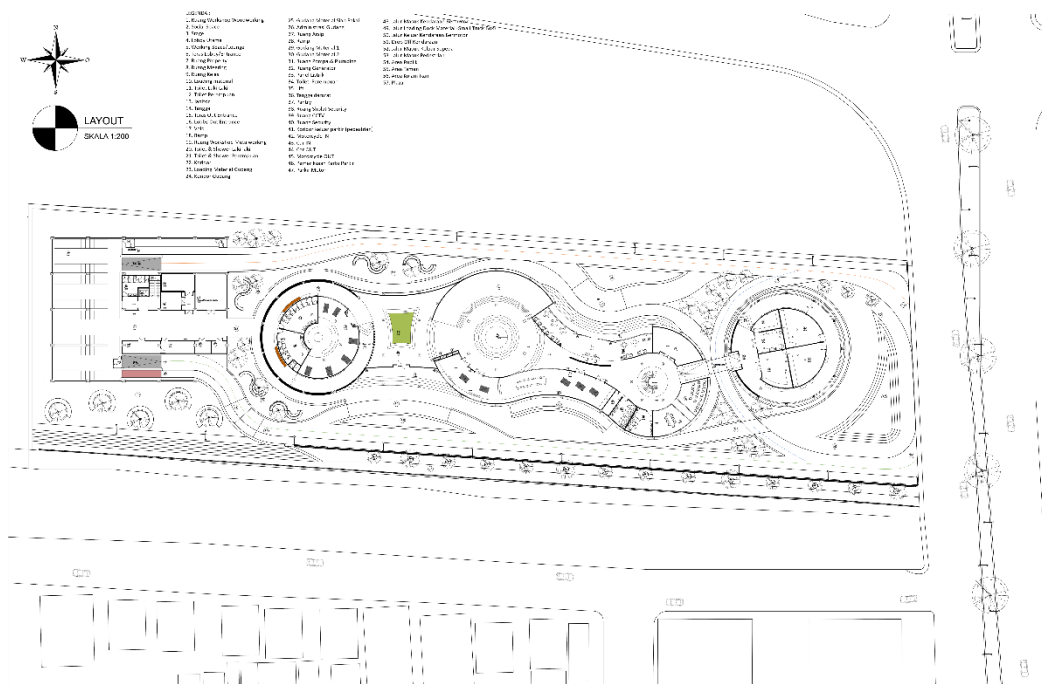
1 Siteplan (ilustrasi Penulis)
